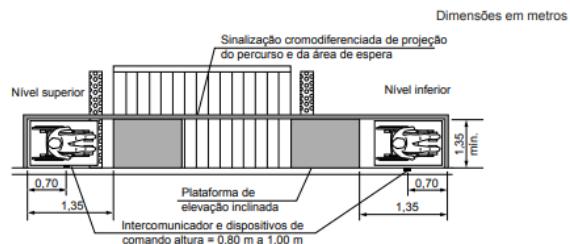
Sinalização de piso junto à plataforma de elevação inclinada – Vista superior
